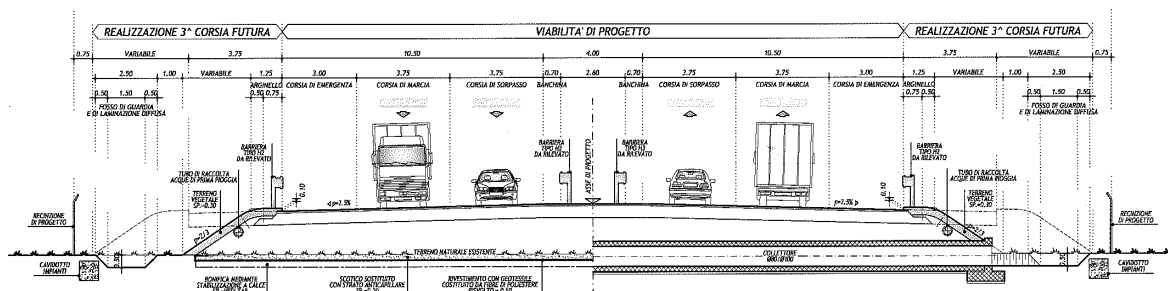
SEZIONE TIPO IN RETTILINEO
